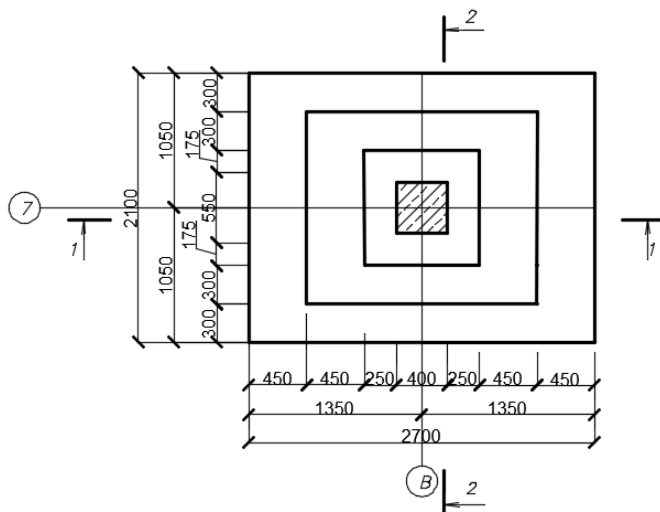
Схема к расчету арматуры плитной части фундамента
